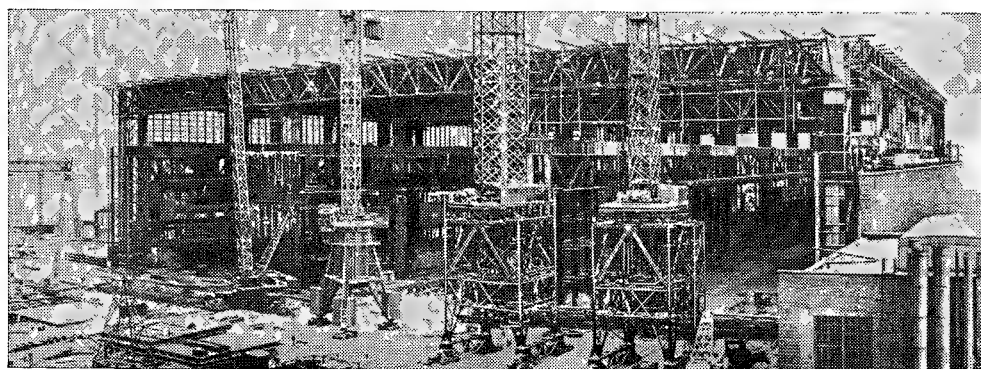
Монтаж каркаса большепролетного сборочно-сварочного цеха
